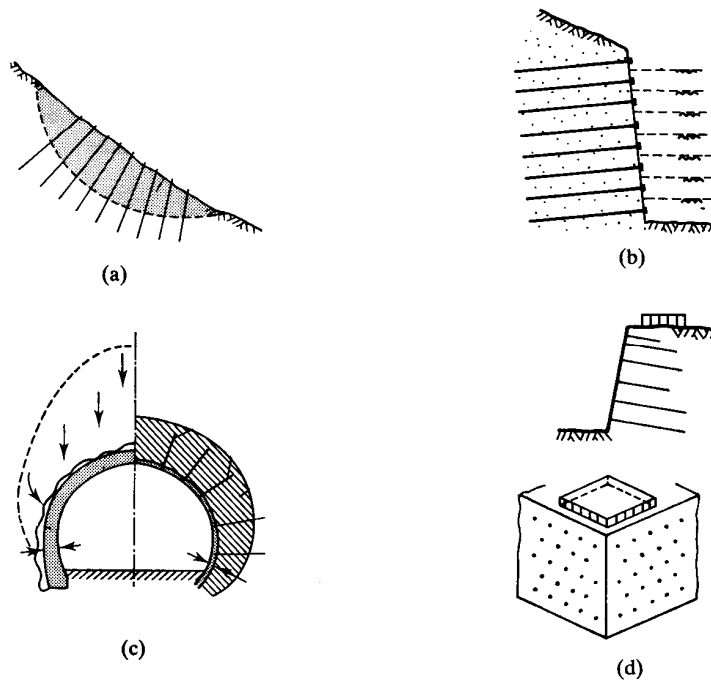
, Aplicaciones típicas del soil nailing:
